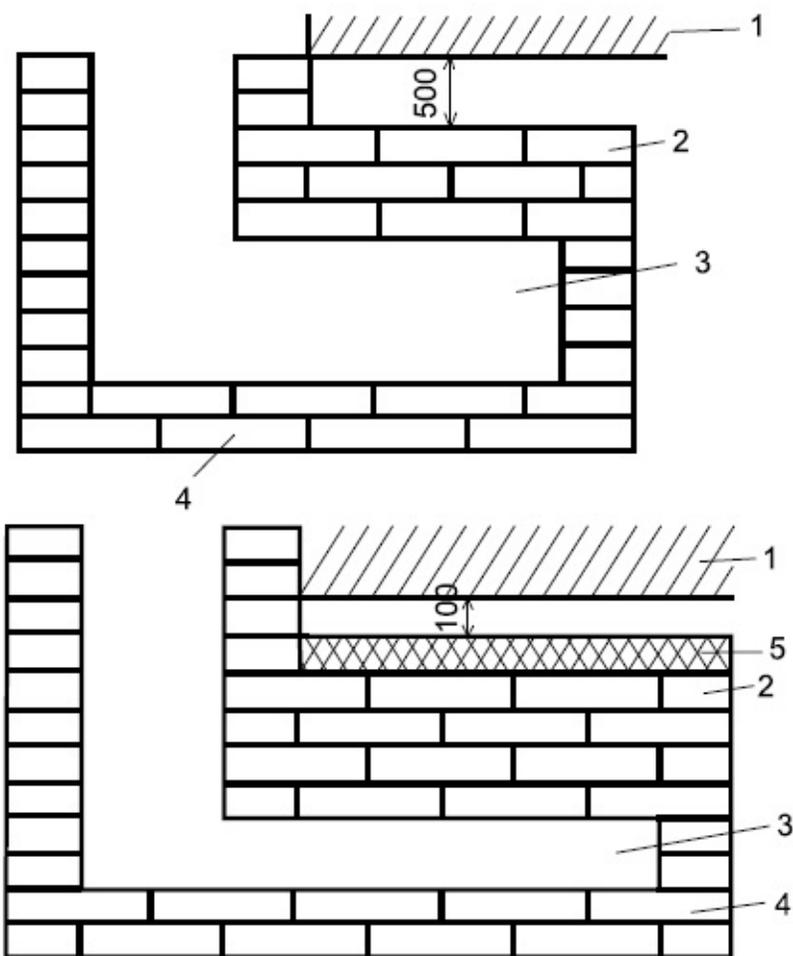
Способ кладки отопительных щитков: 1 – потолок; 2 – перекрыша; 3 – дымовой канал; 4 – кирпичная кладка; 5 – термостойкая негорючая теплоизоляция
